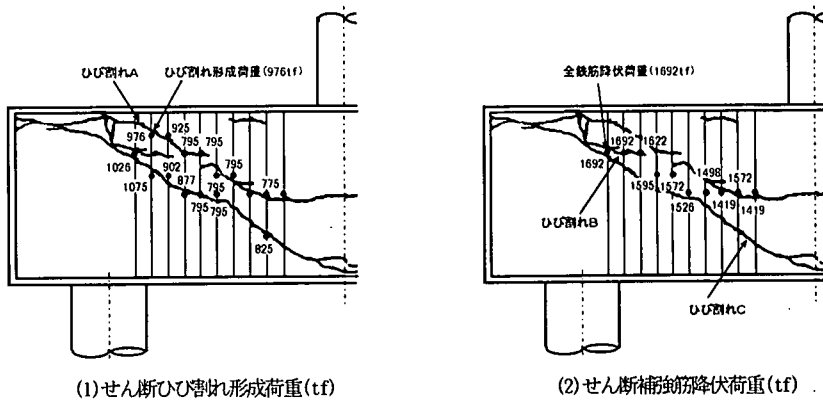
試験体No. 1のひび割れ、せん断補強筋降伏の進展の様子
